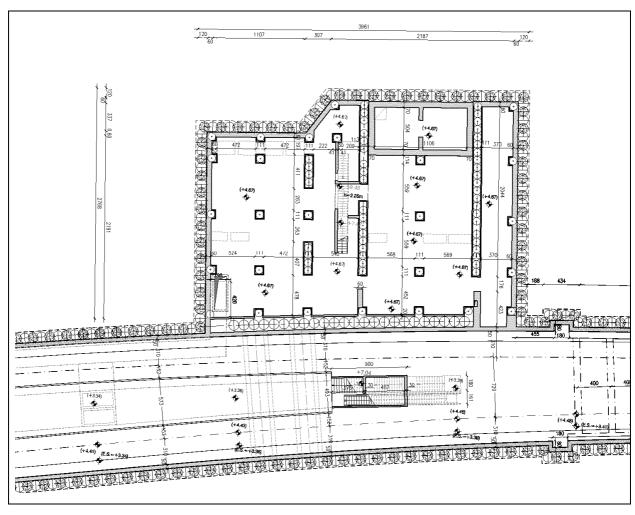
Stazione Politeama – Locali tecnici – Pianta quota banchina
